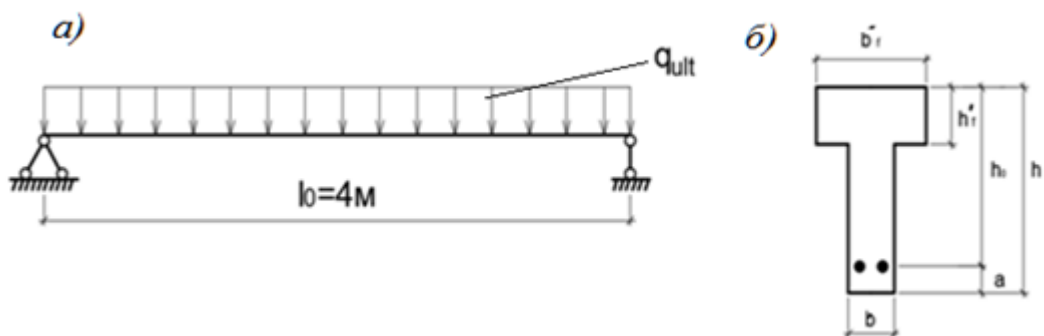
Расчетная схема (а) и расчетное сечение (б) к задаче №22
